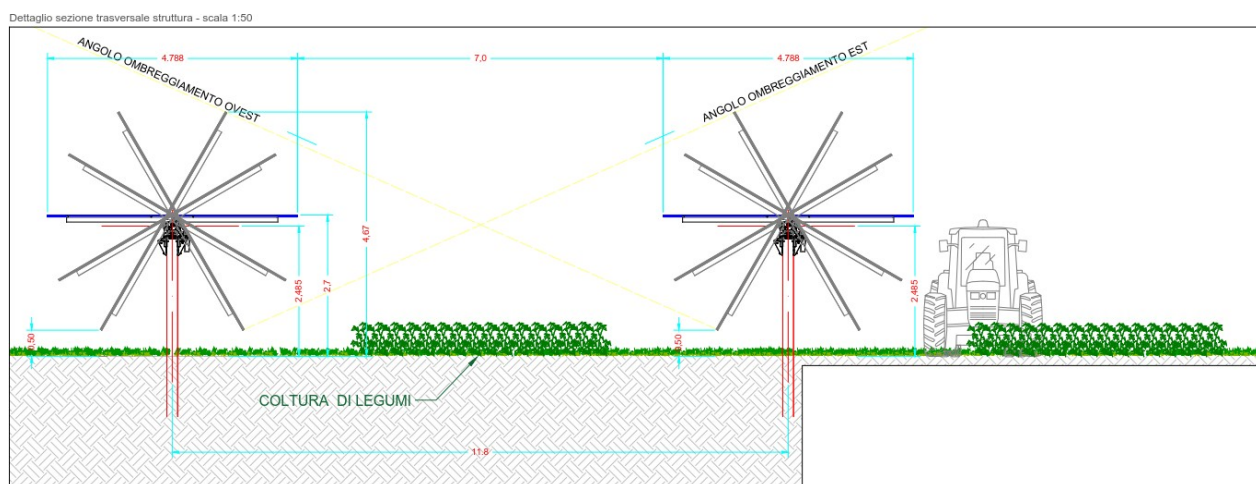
Particolare disposizione strutture di sostegno e spazio tra le file
